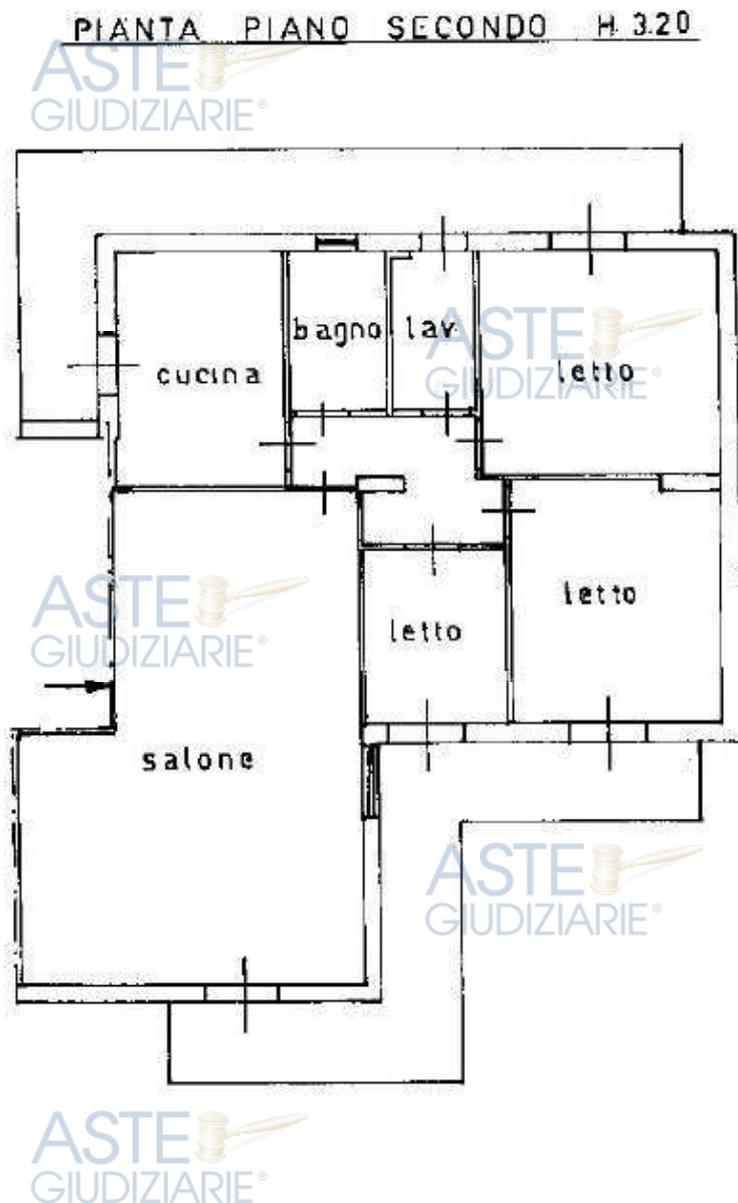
Planimetria Catastale appartamento Via Pirandello, 26 – Misterbianco
